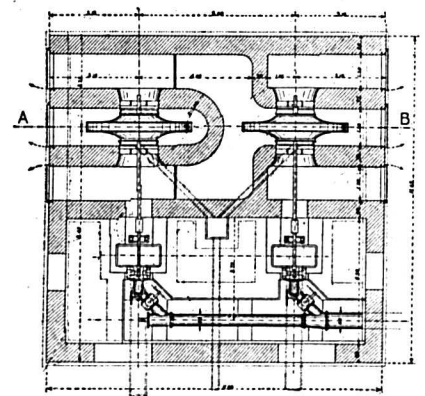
Plan des installations de la ventilation du tunnel du côté d'Iselle.
